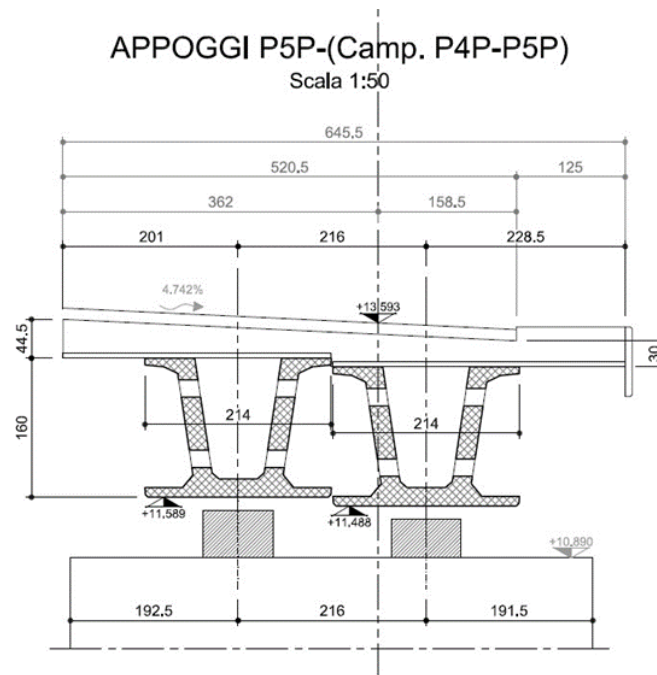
Sezione trasversale Campata 5 (a 2 travi) – Rampa P – P5_P
